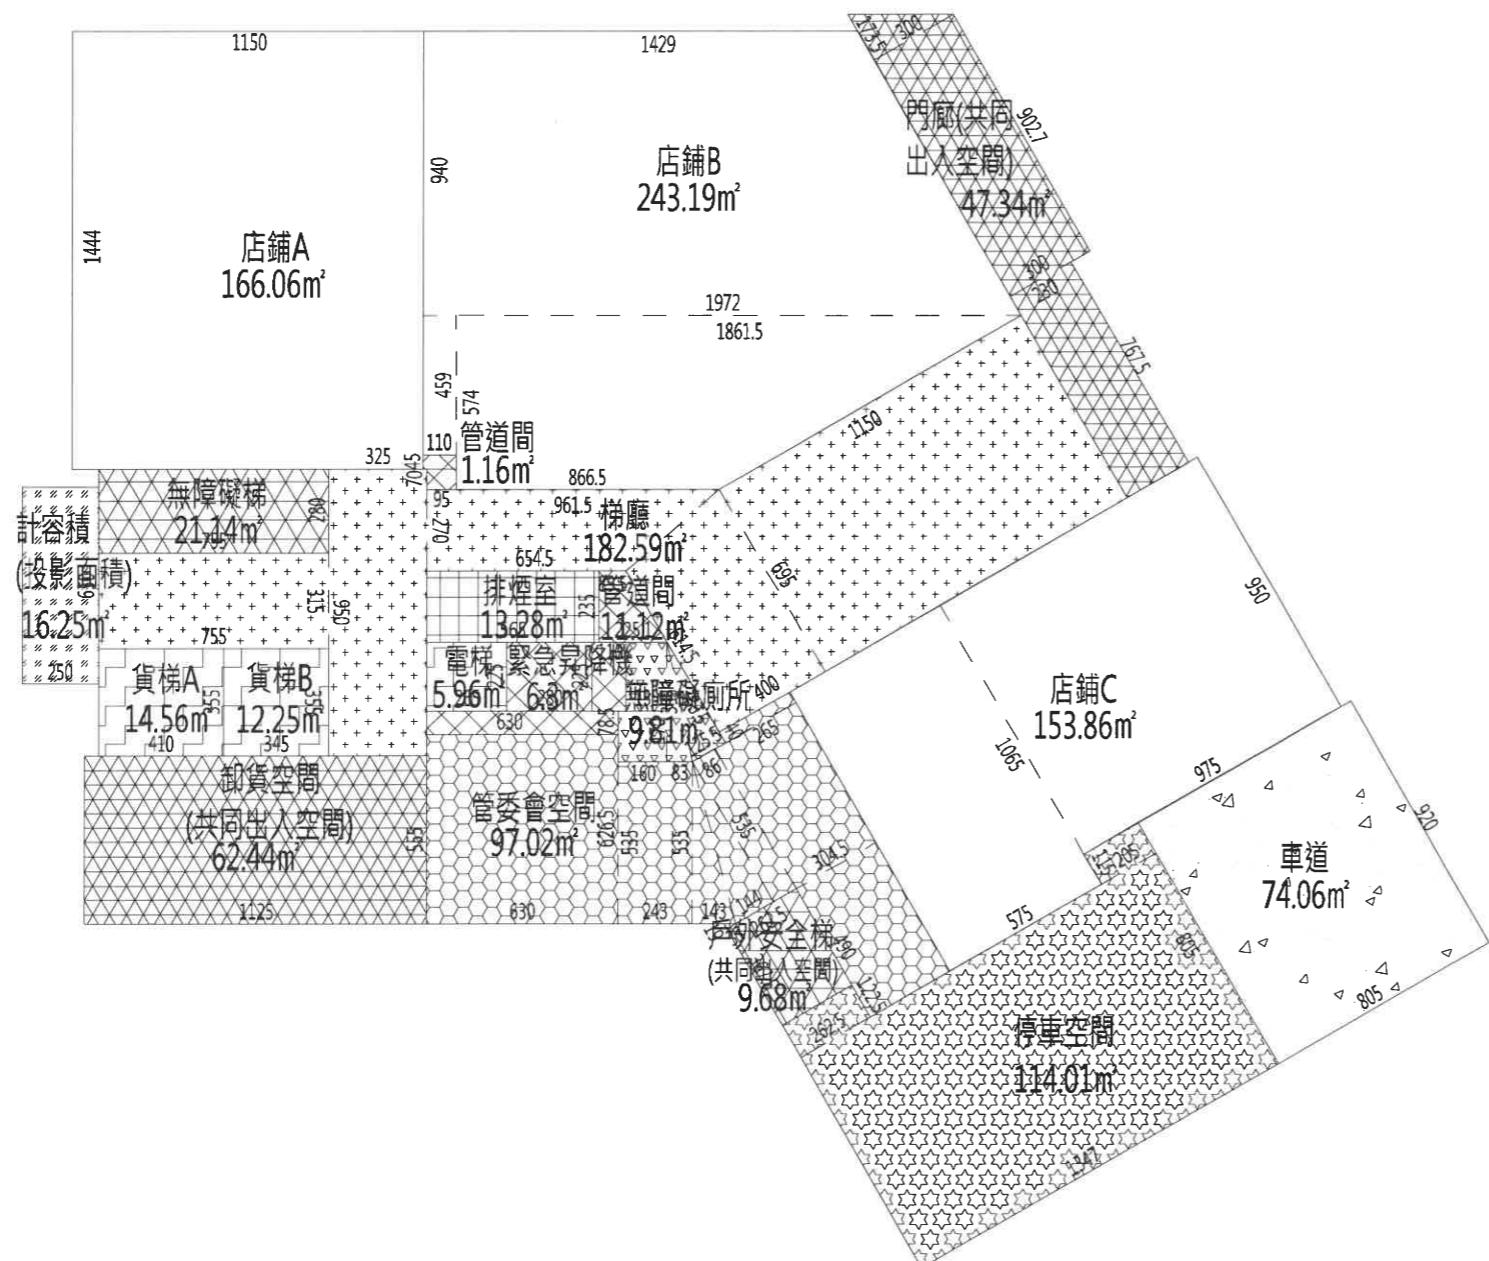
地上一層平面圖(變更後)(S:1/300)
